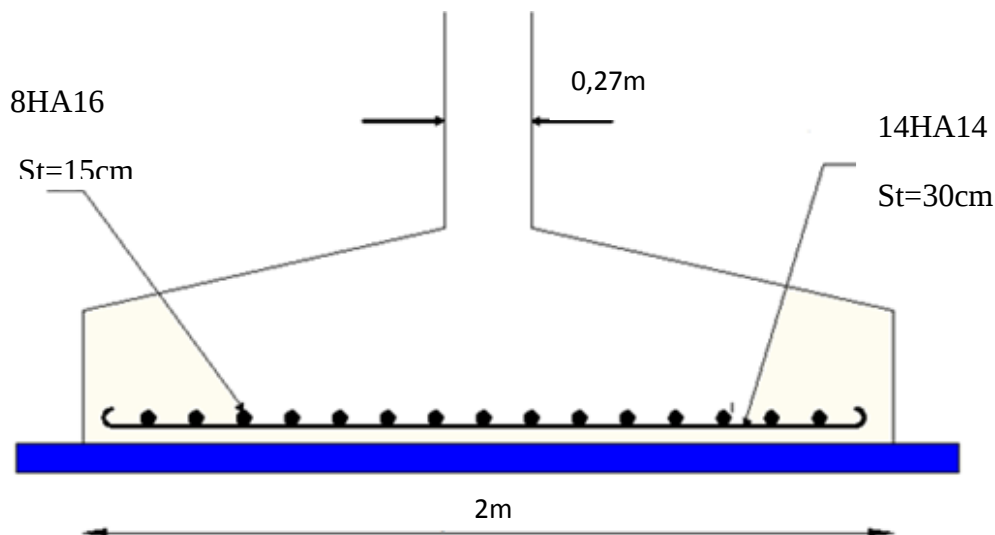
Schéma de ferrailage de la semelle du poteau
